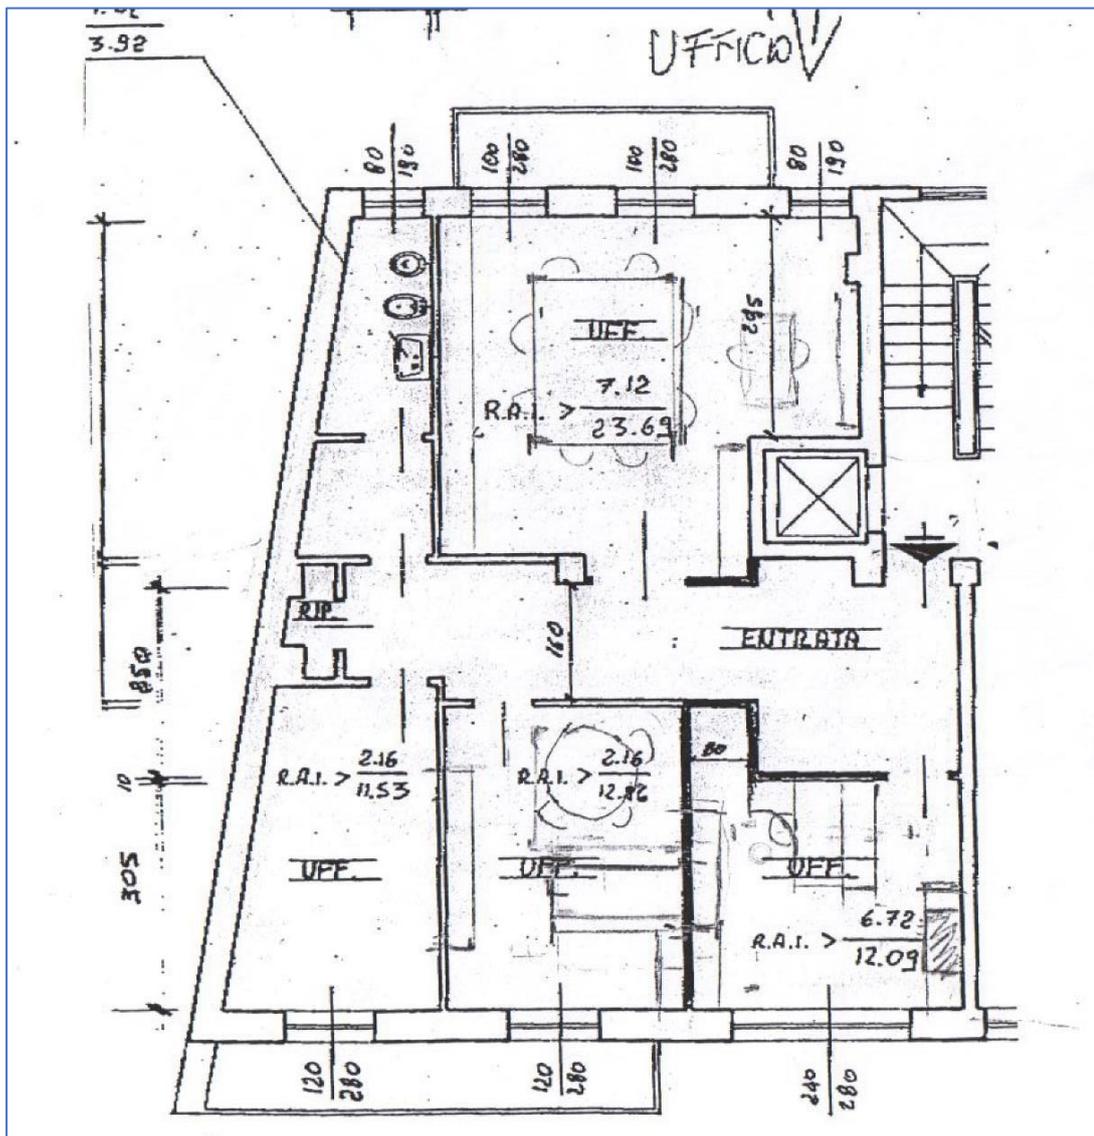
stato di fatto rilevato - planimetria allegata al contratto di locazione non rinnovato
